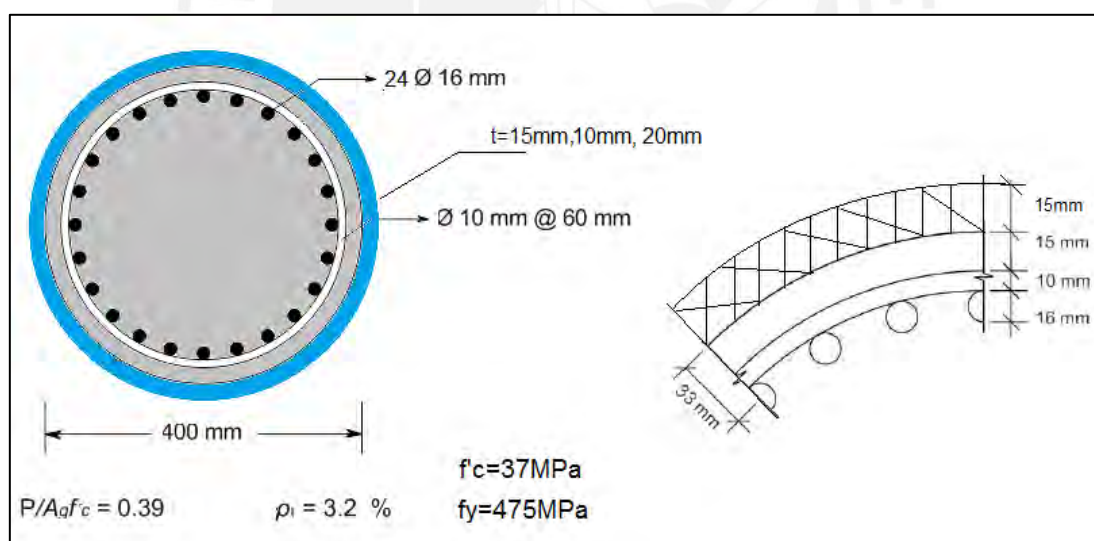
Sección circular de concreto armado de diámetro 400mm enfundado con lámina de acero
